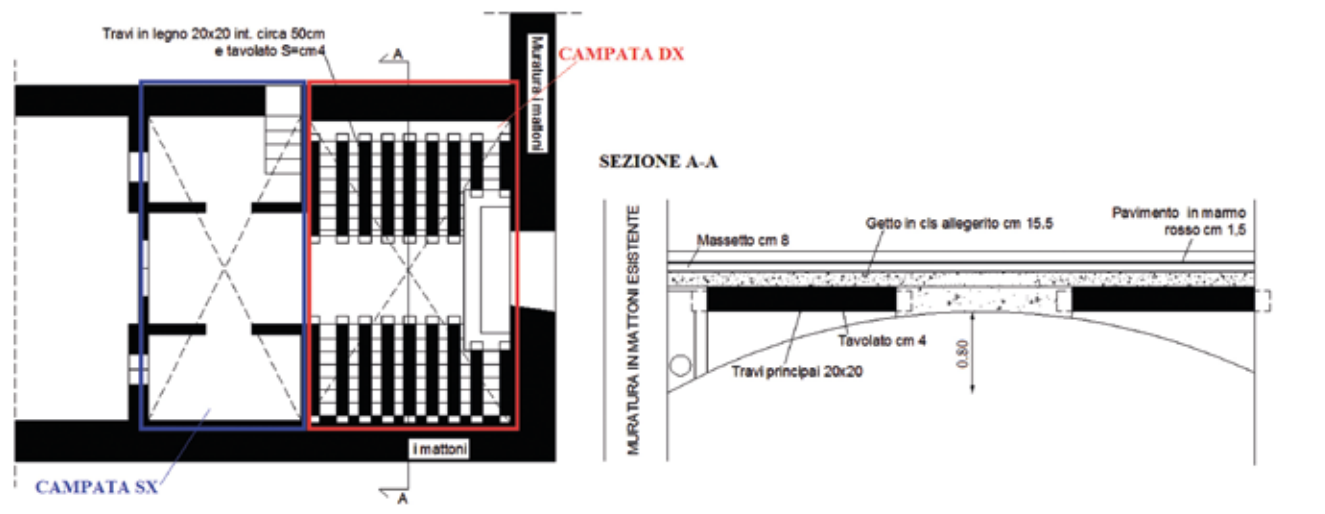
Schematizzazione solaio oggetto di intervento - Stato attuale
